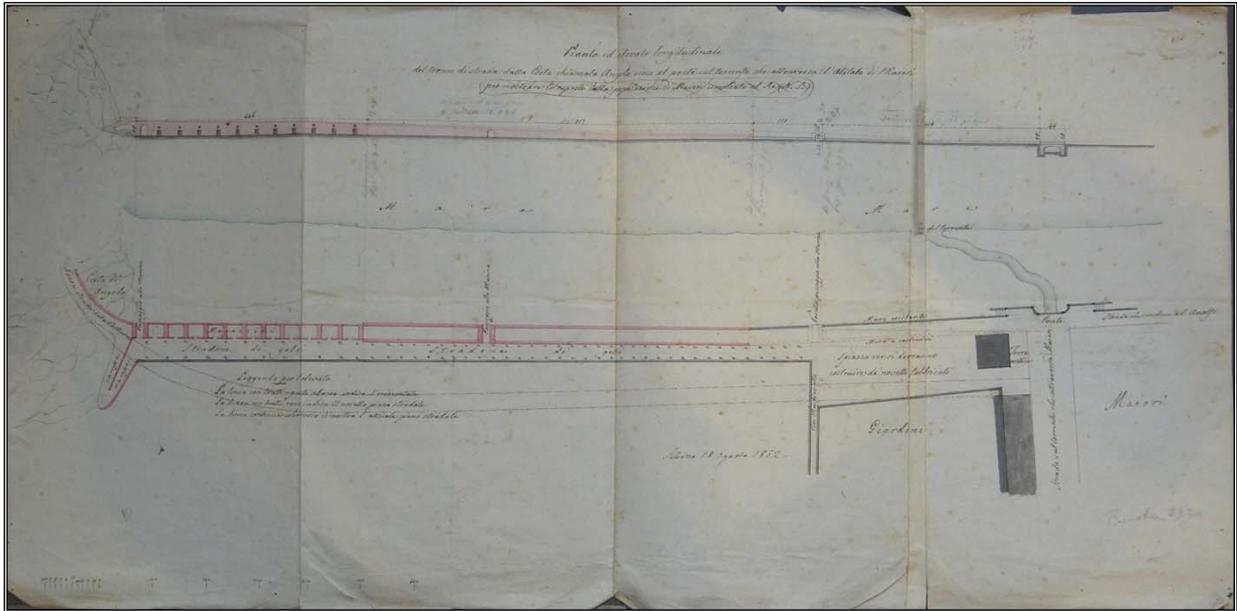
“Pianta ed elevato longitudinale del tratto di strada della costa chiamata Angolo sino al ponte sul torrente che attraversa l’abitato di Maiori”, 18/8/1852. Archivio di Stato di Salerno.
